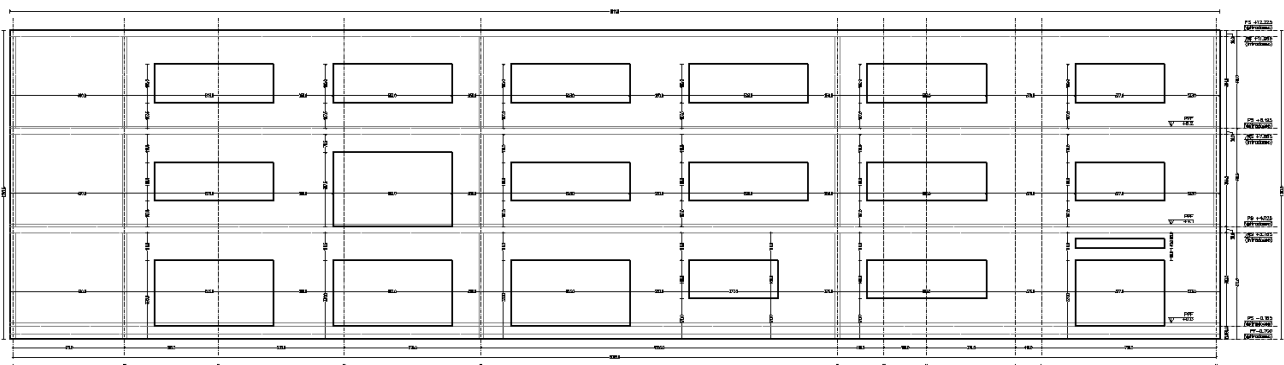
Prospetto nord-ovest setti scuola: strutture in progetto
